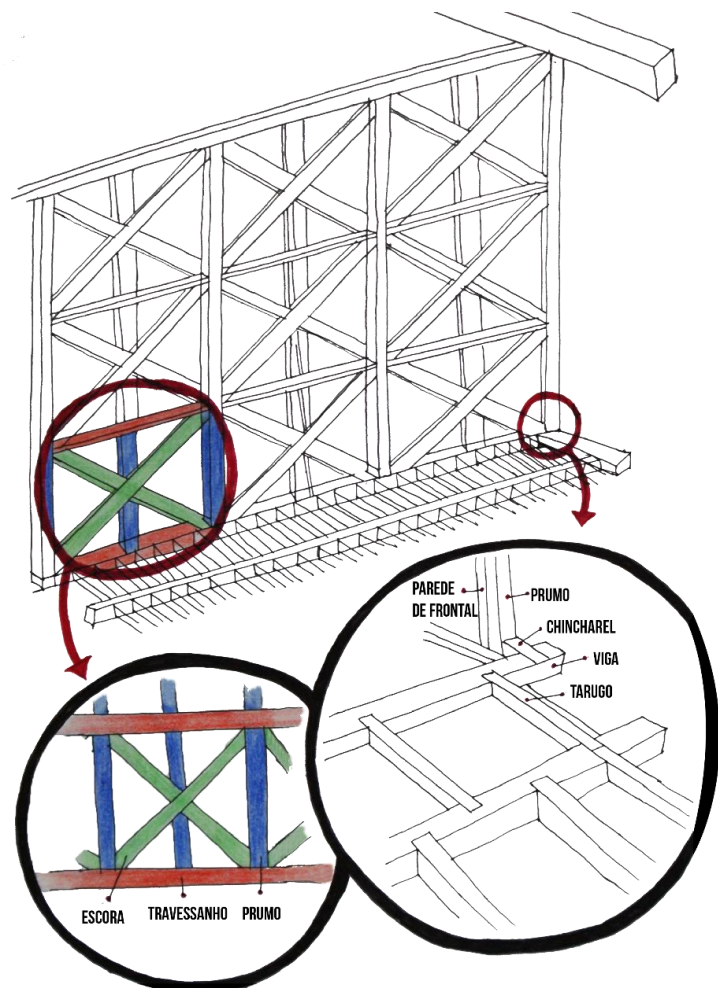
Identificação de elementos da estrutura de madeira da gaiola _ Fonte: ilustração da autora
